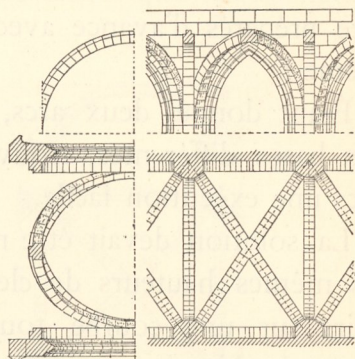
Croisée d'ogive sur plan rectangulaire, arcs directeurs ogivaux, arc diagonal plein cintre.
